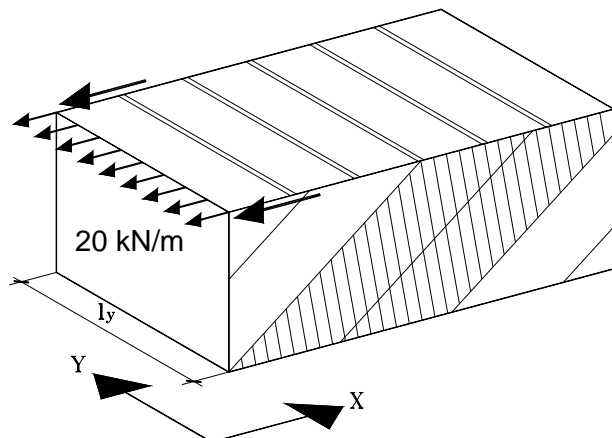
Planchers en bois constitués de poutres (direction x), entretoises et tirants (direction y) et couvert d'éléments en contreplaqué cloués aux poutres et entretoises.
